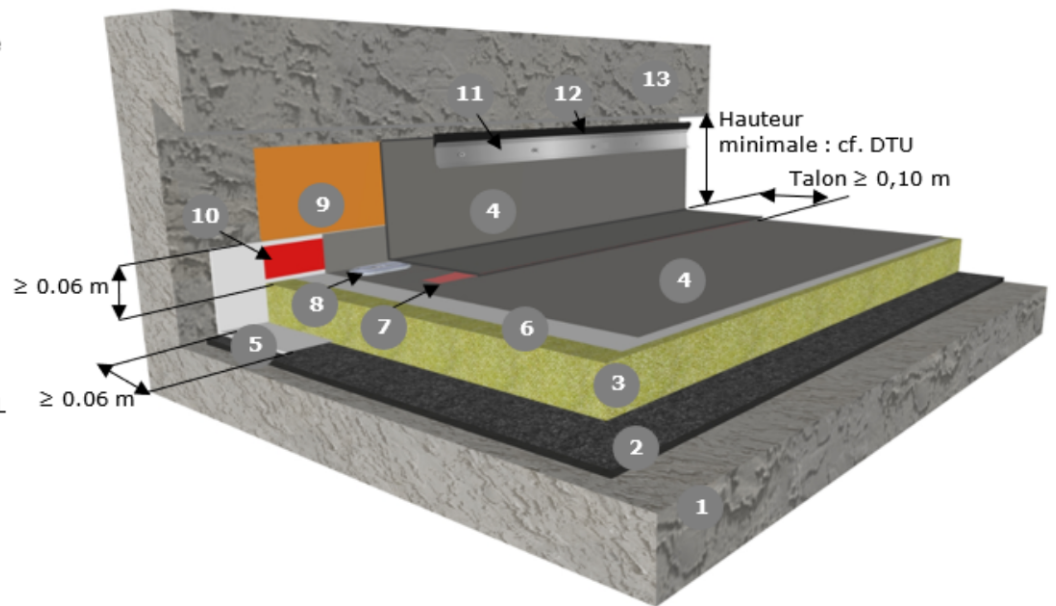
Relevés d'étanchéité avec bande de serrage (maçonnerie)
